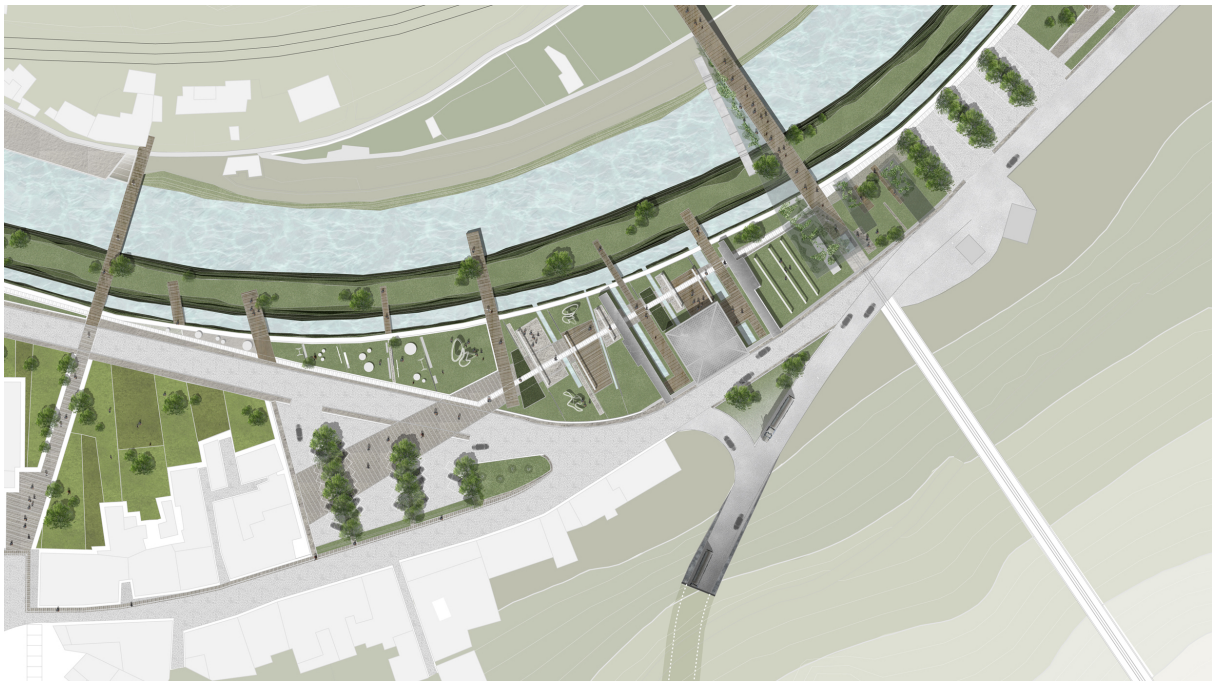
Masterplan area di progetto - credits: Gioia Di Marzio
